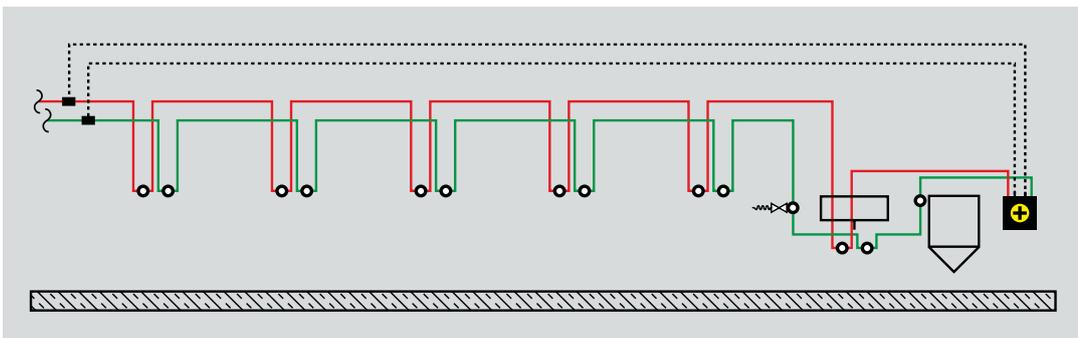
Strangschema – Sporthalle – Spülstation mit MFS
